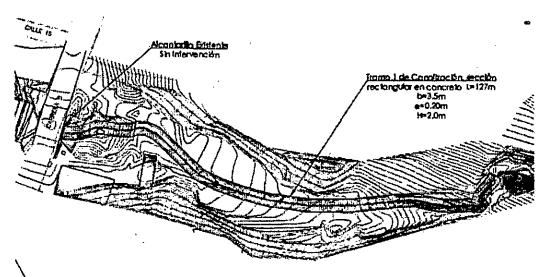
Ubicación del tramo 1, quebrada El Balso Fuente: Girmava SAS, 2024
